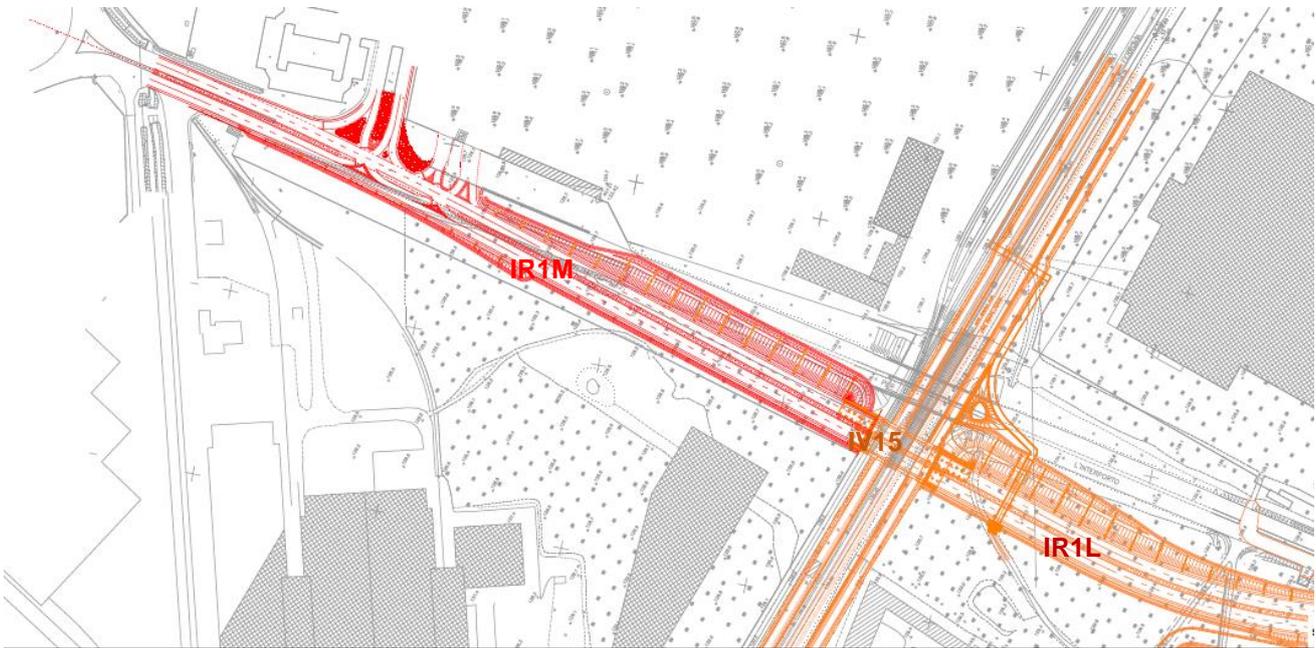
Localizzazione della rampa di approccio IR1M nel progetto in variante (in colore rosso)
